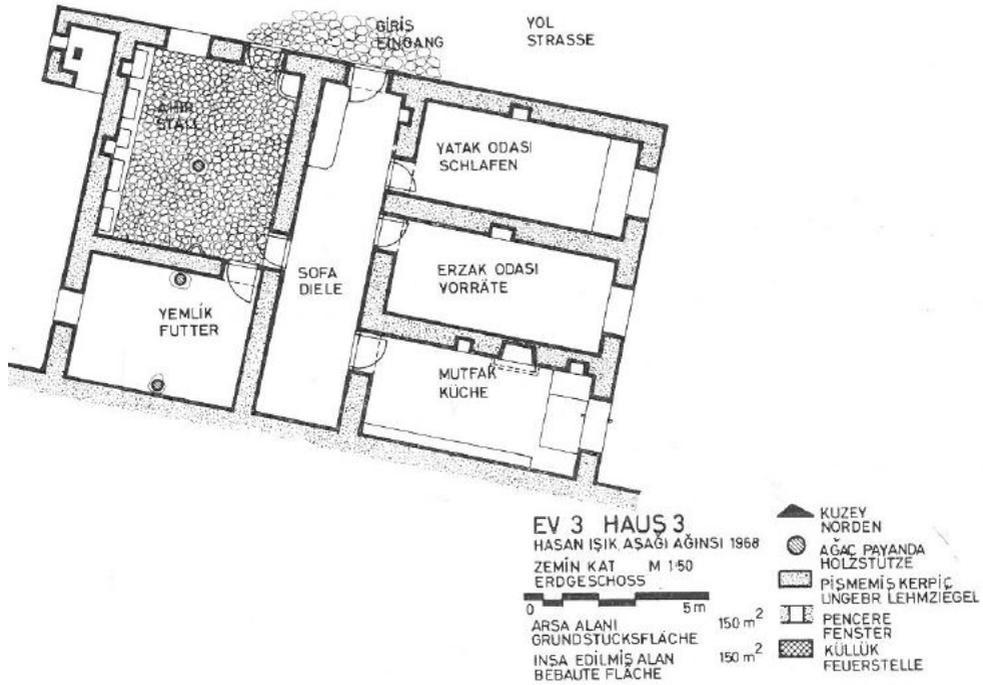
Grundriss Haus 3 mit zentraler Diele
